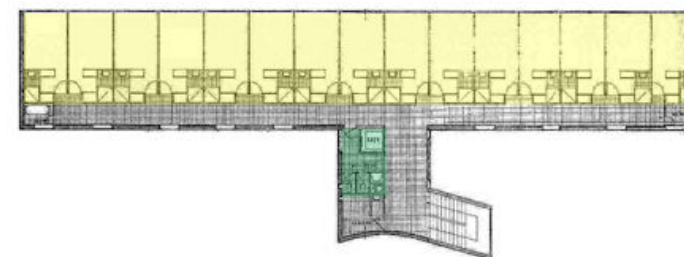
Planta pavimento tipo | Fonte: archigraphie.eu
